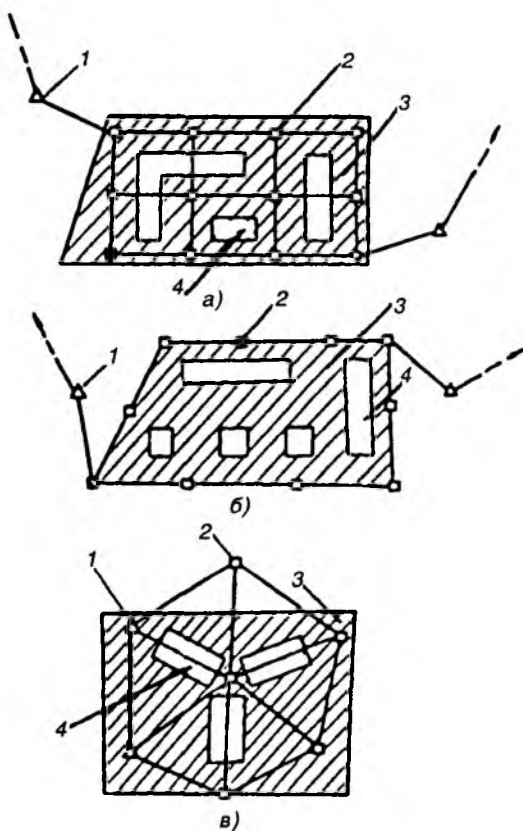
Схемы разбивочных сетей строительной площадки и здания:
